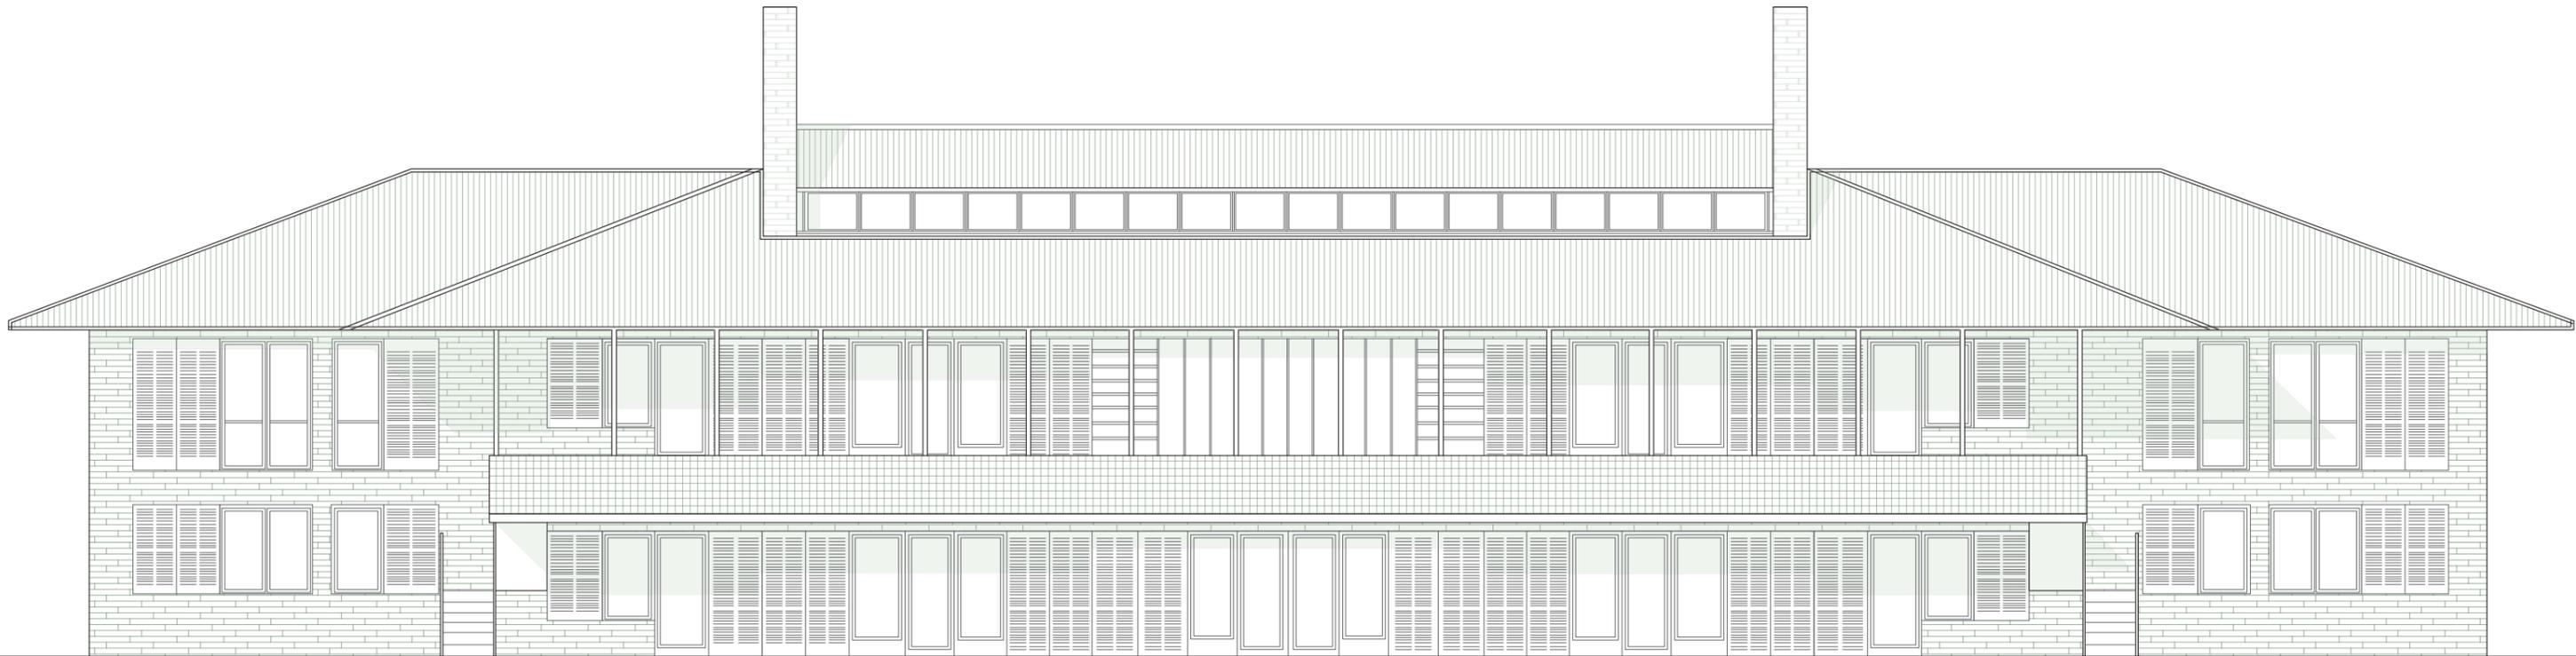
Alzado sur, Casa Añón. Escala 1:100
